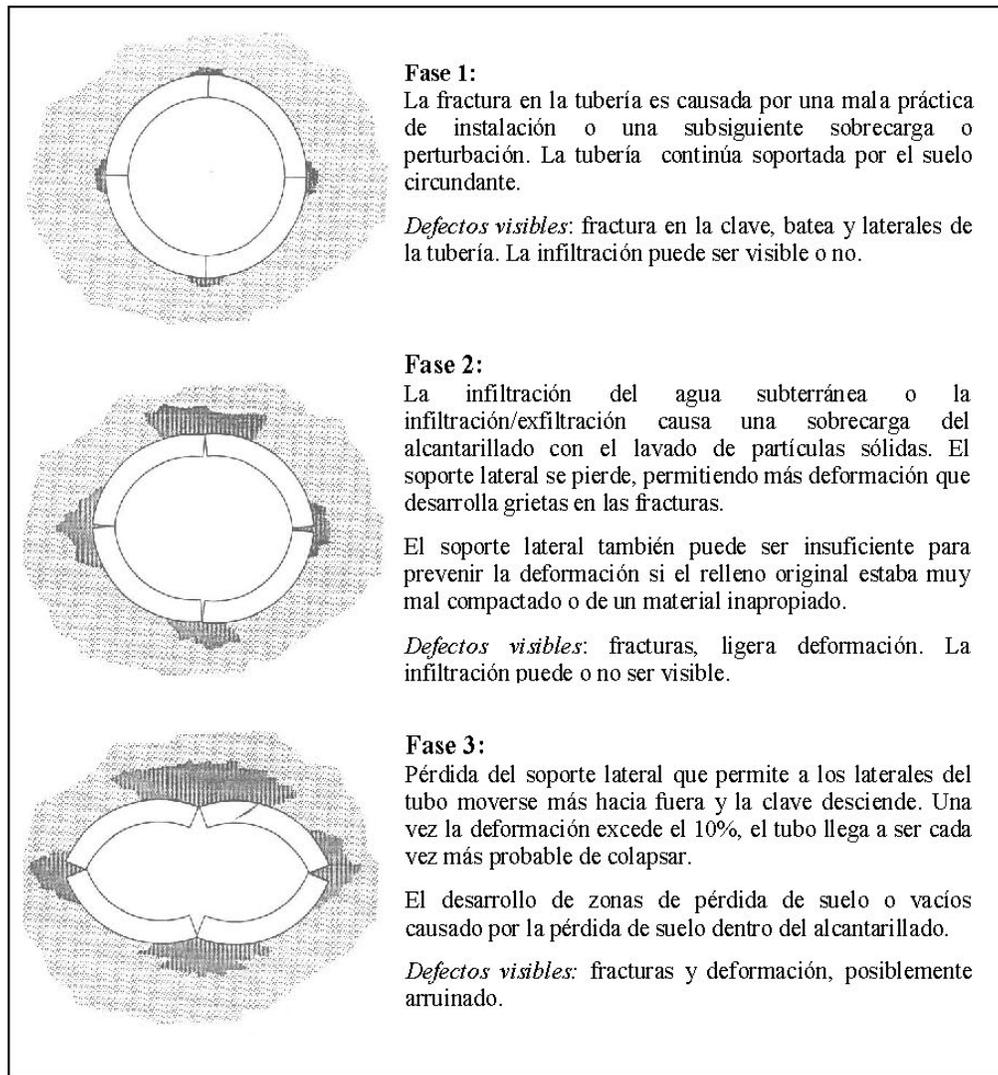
Deformación de tuberías con grietas⁵.
